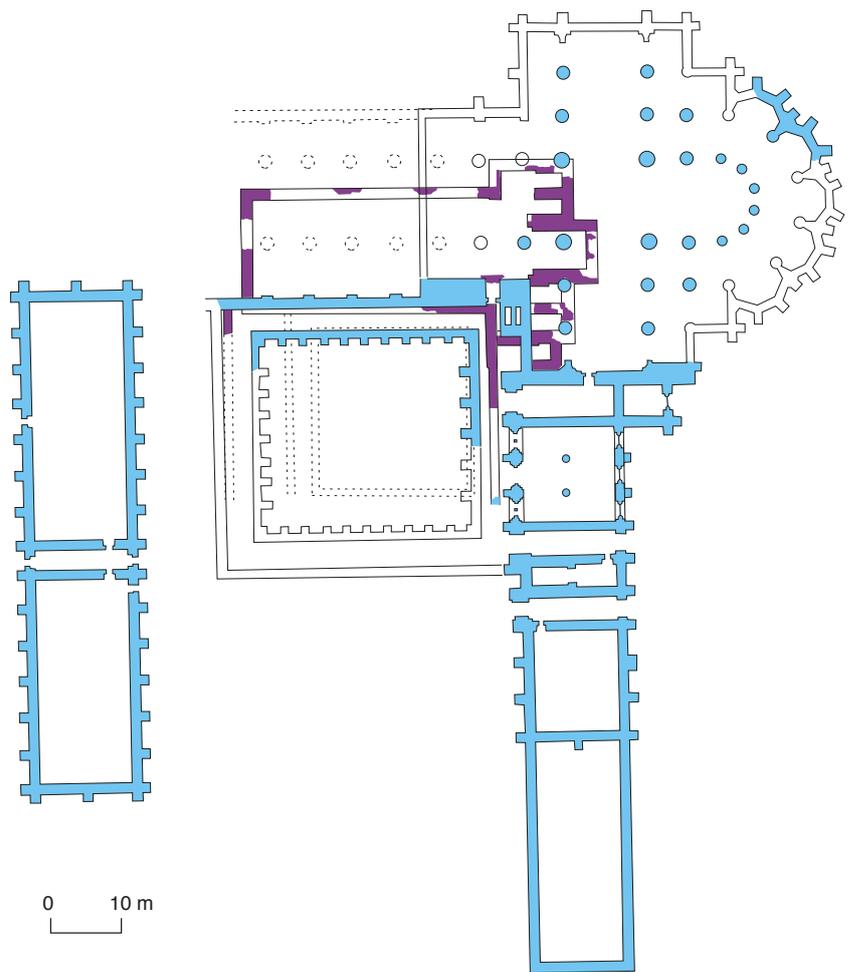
Vaclair, Grundriss der Zisterzienserklosteranlage mit der Kirche des 12. Jh. und der unfertigen, 1257 geweihten gotischen Kirche (M. Untermann, Heidelberg).
